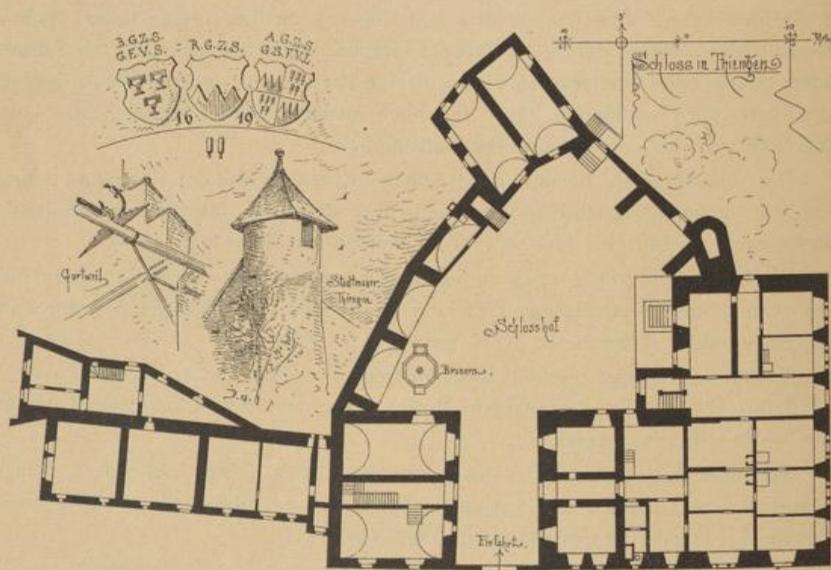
Gurtweil, Detail. — Thiengen, Grundriss des Schlosses.
